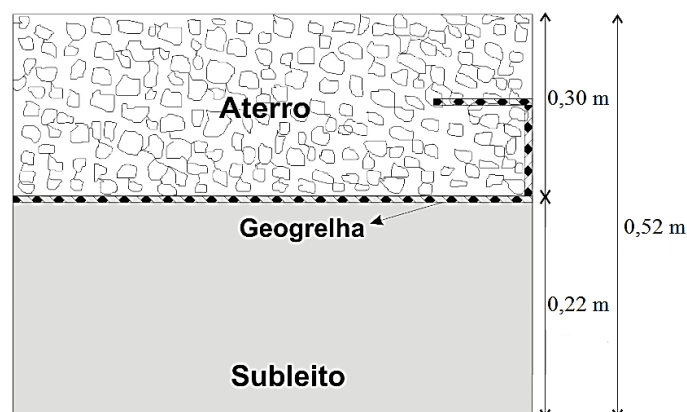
Seção transversal de parte da estrada não pavimentada simulada nos ensaios com detalhe da ancoragem da extremidade do reforço.
